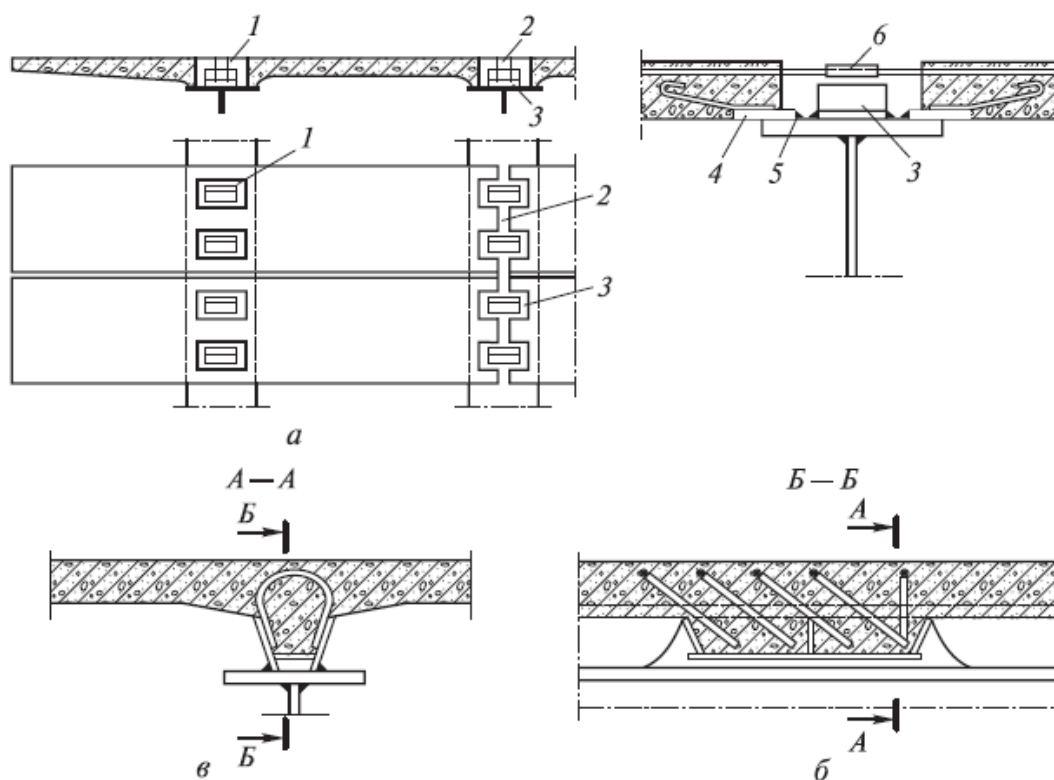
Способы (а—в) соединения блоков сборной железобетонной плиты со стальными балками:
